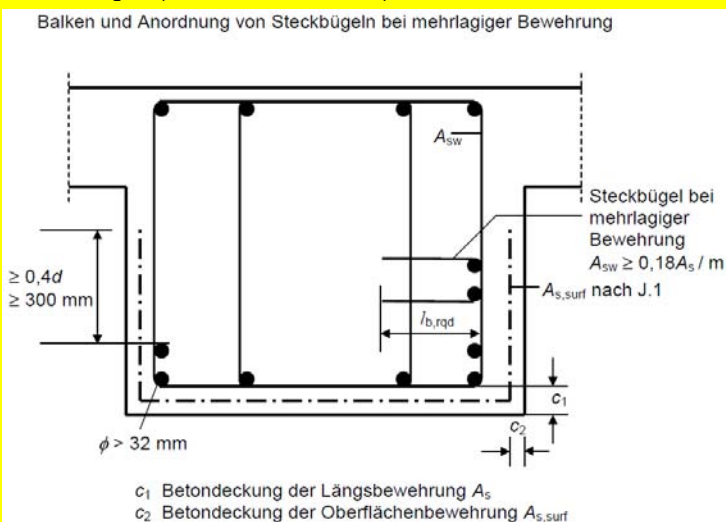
Balken und Anordnung von Steckbügeln bei mehrlagiger Bewehrung $\phi > 32$ mm
